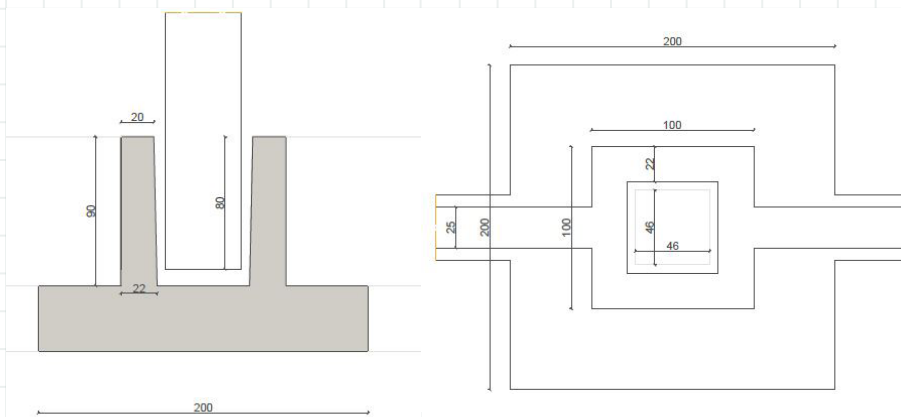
sezione verticale e pianta del plinto a bicchiere e innesto del muro di fondazione
